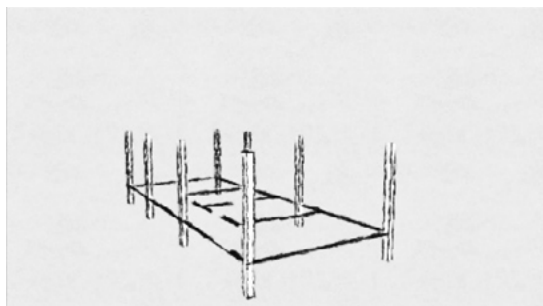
Plantas do sistema construtivo da Casa de Chico Mendes 1
